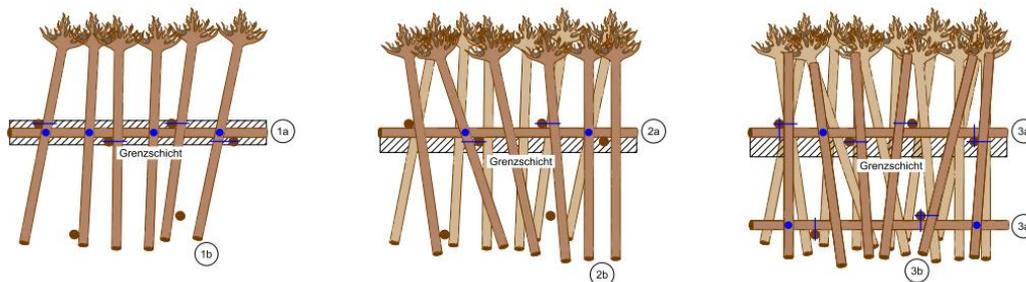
Schematischer Grundriss des lagenweisen Aufbaus eines ELJ-Elements (erste drei Lagen). Die dritte Lage ist hier ausnahmsweise ohne Wurzelteller dargestellt, dies sollte aber nur in speziellen Anwendungen so erfolgen. Im Regelfall werden sämtliche Lagen unterhalb Wasserspiegel Mittelwasser mit Wurzettellern ausgebildet.
